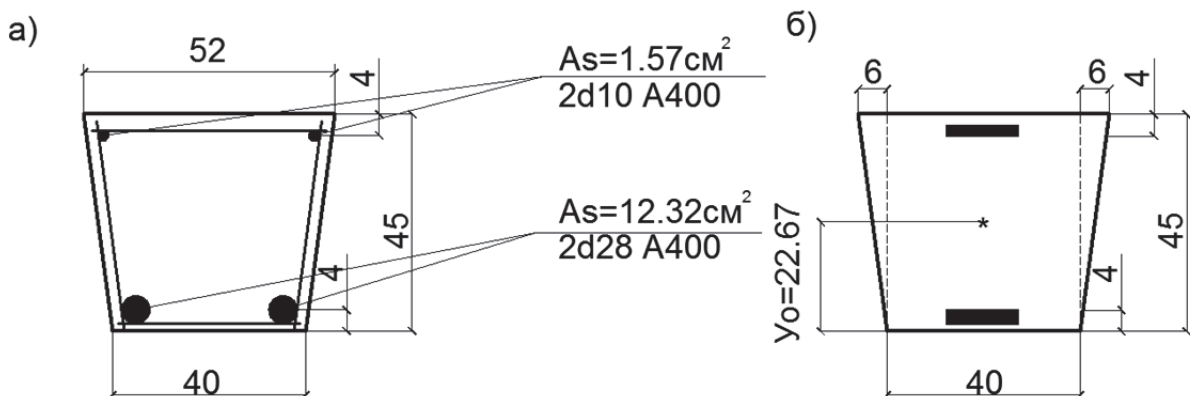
Армирование балки (а) и схема для вычисления центра тяжести (б)
